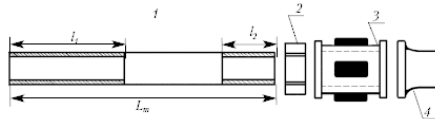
Сгон и соединительные детали: 1 – фитинги; 2 – контр-гайка; 3 – муфта соединительная; 4 – патрубок с резьбой
